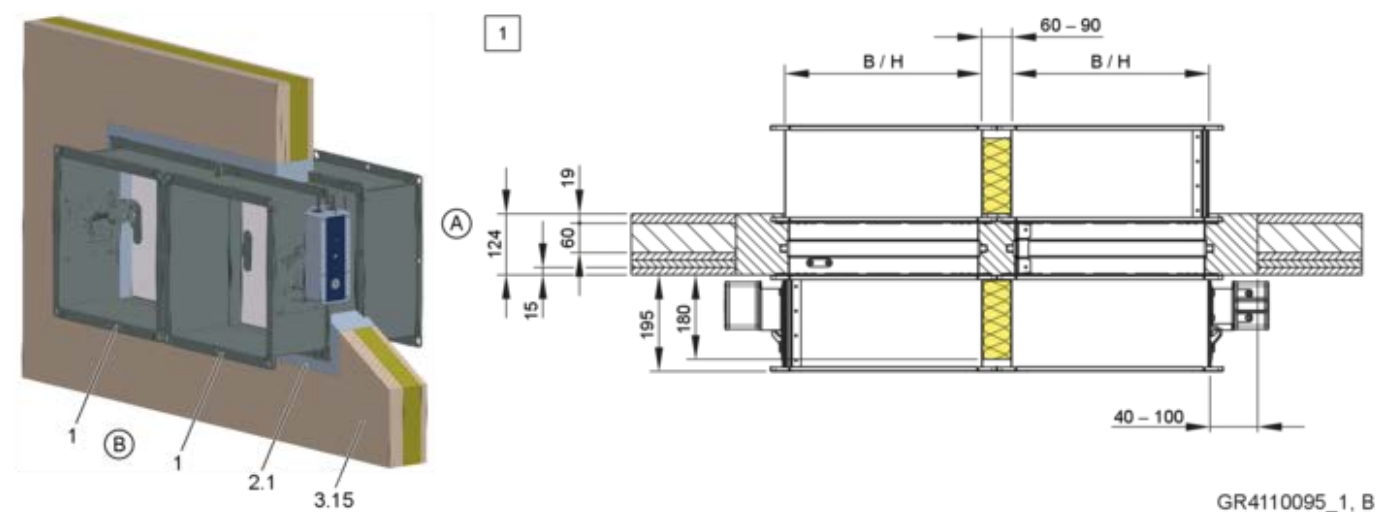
Montagem em argamassa em paredes de caixa assimétricas, "flange a flange", desenhadas uma ao lado da outra (também se aplica à montagem uma abaixo da outra)
